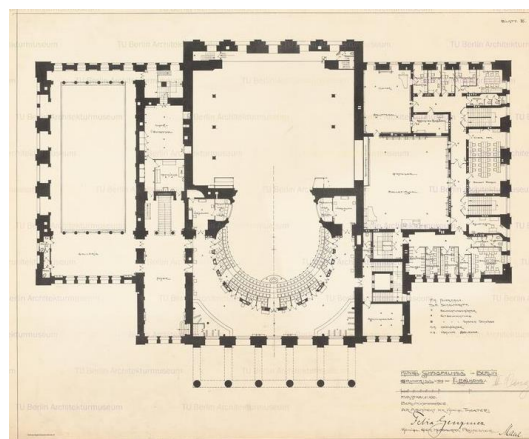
Planta do teatro *Schauspielhaus*, Berlim
